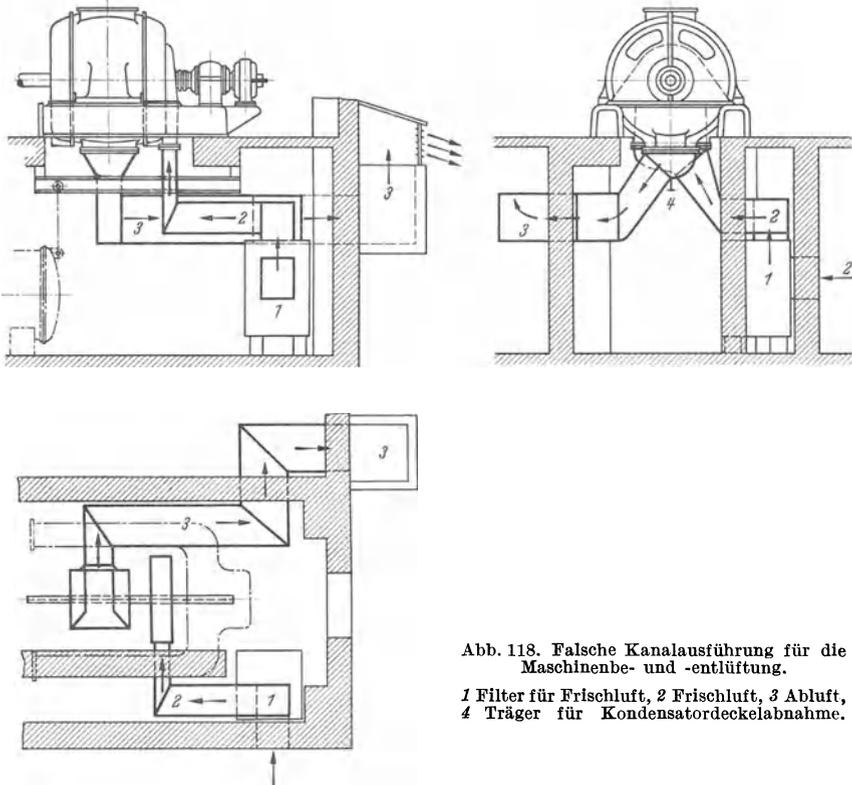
Falsche Kanalausführung für die Maschinenbe- und -entlüftung.
